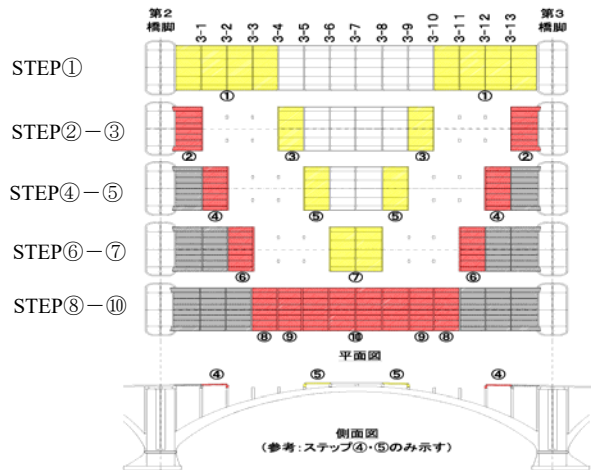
橋梁撤去・架替えの施工順序 (第3径間)
